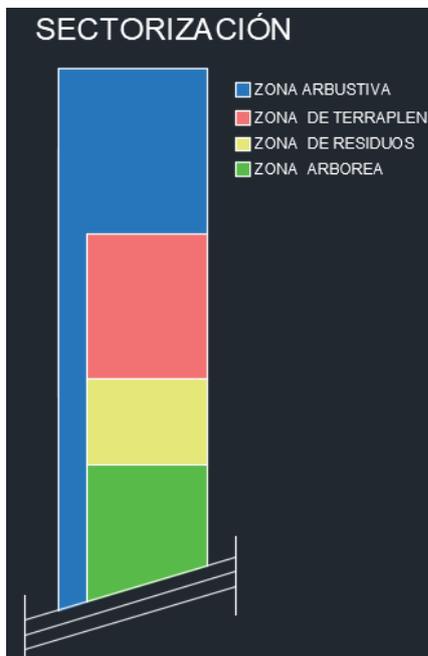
Plano del predio dividido en sectores. Fuente: Propia.
